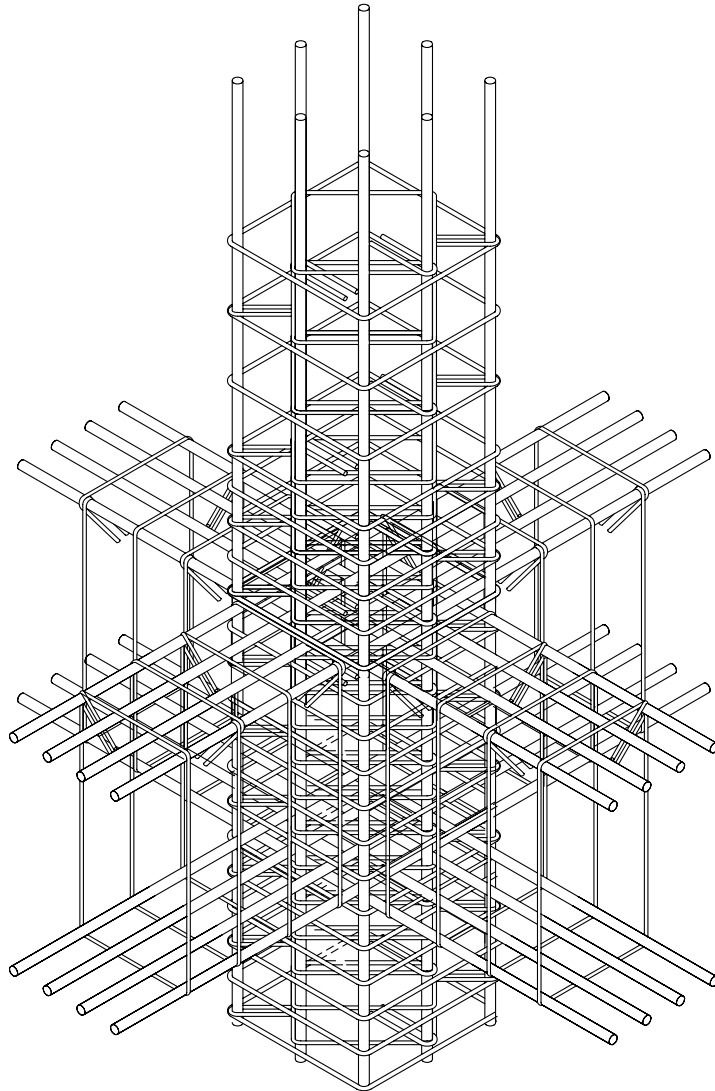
Acumulación de armaduras en un nodo típico de estructura porticada
